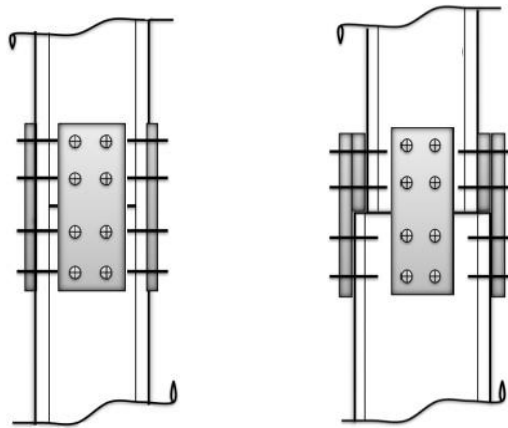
Assemblage poteau-poteau a section égale et section différente.
